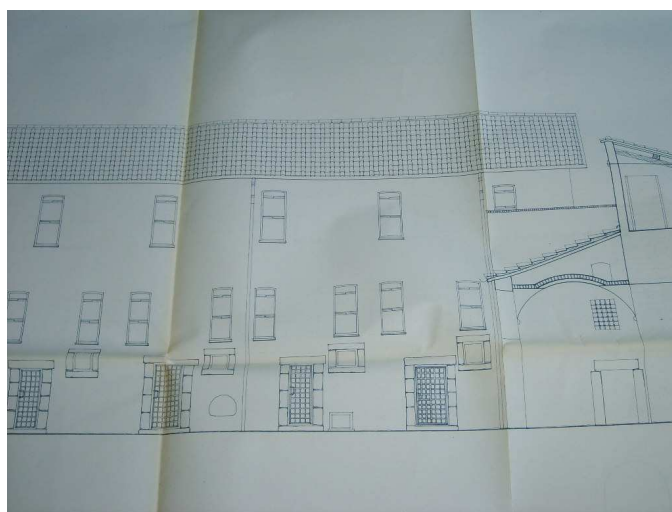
progetto SBAPL-1° cortile-corpo est prospetto-(stralcio) e sezione corpo sud
